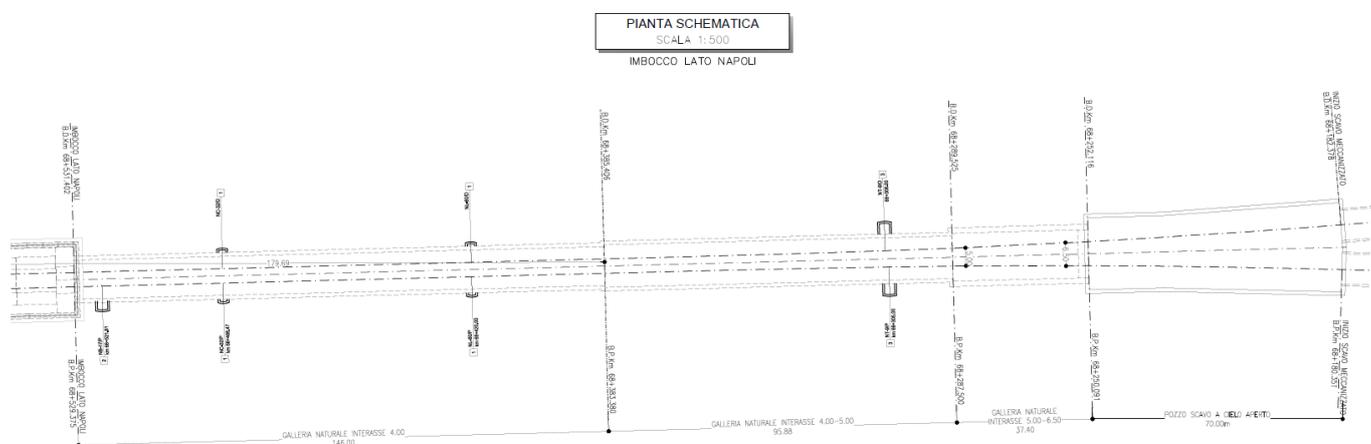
Planimetria generale tratta in tradizionale lato Napoli
